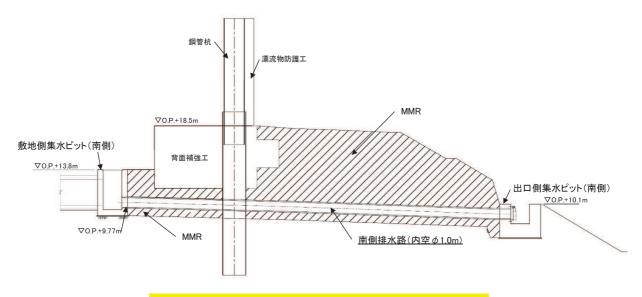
(2) 南側排水路配置図(縦断図, 1-1'断面)
